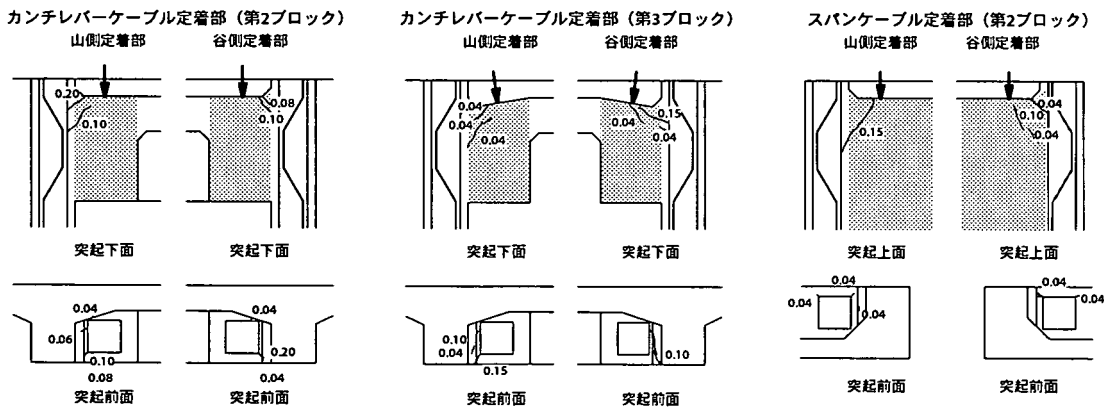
大宮大台橋外ケーブル定着部試験 ひび割れ発生状況
